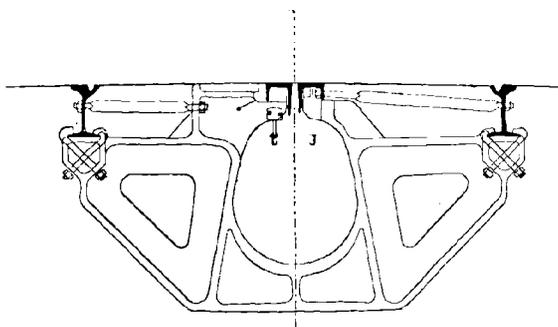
Caniveau de la troisième Avenue, à New-York.
